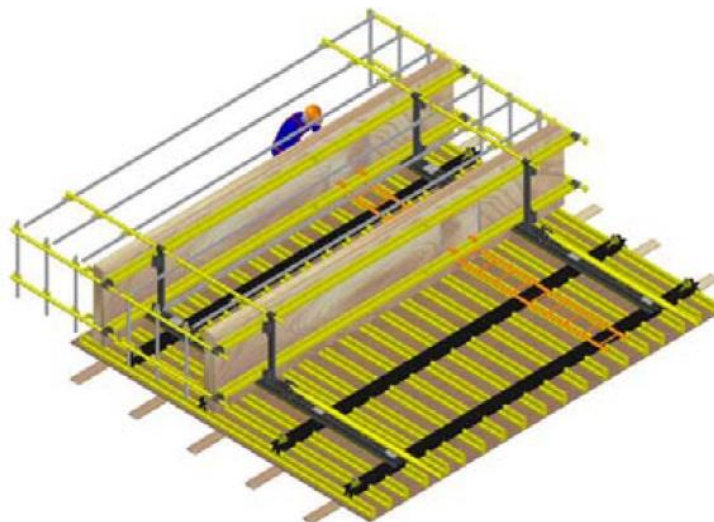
f. Colocación de escaleras. Recuperado de: Ulma Construction, *Instrucción técnica de montaje.
